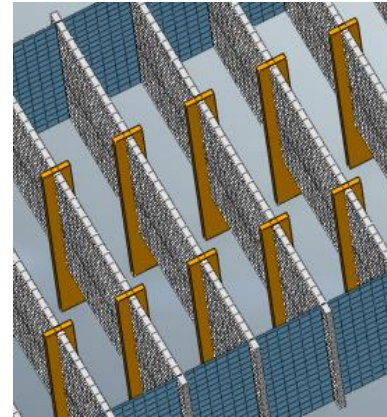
Detalle de arreglo tridimensional de Muro Milán, Contrafuertes y Barretes.
